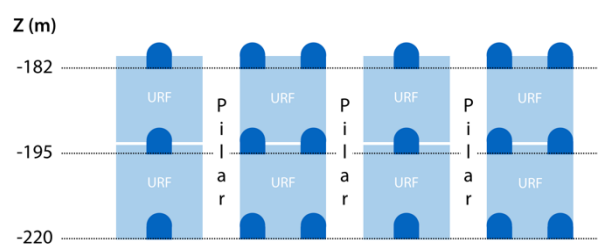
Seção das câmaras extraídas pelo método *Transversal Stope* com pilares adjacentes e já preenchidas com estéril (vista para o norte).
